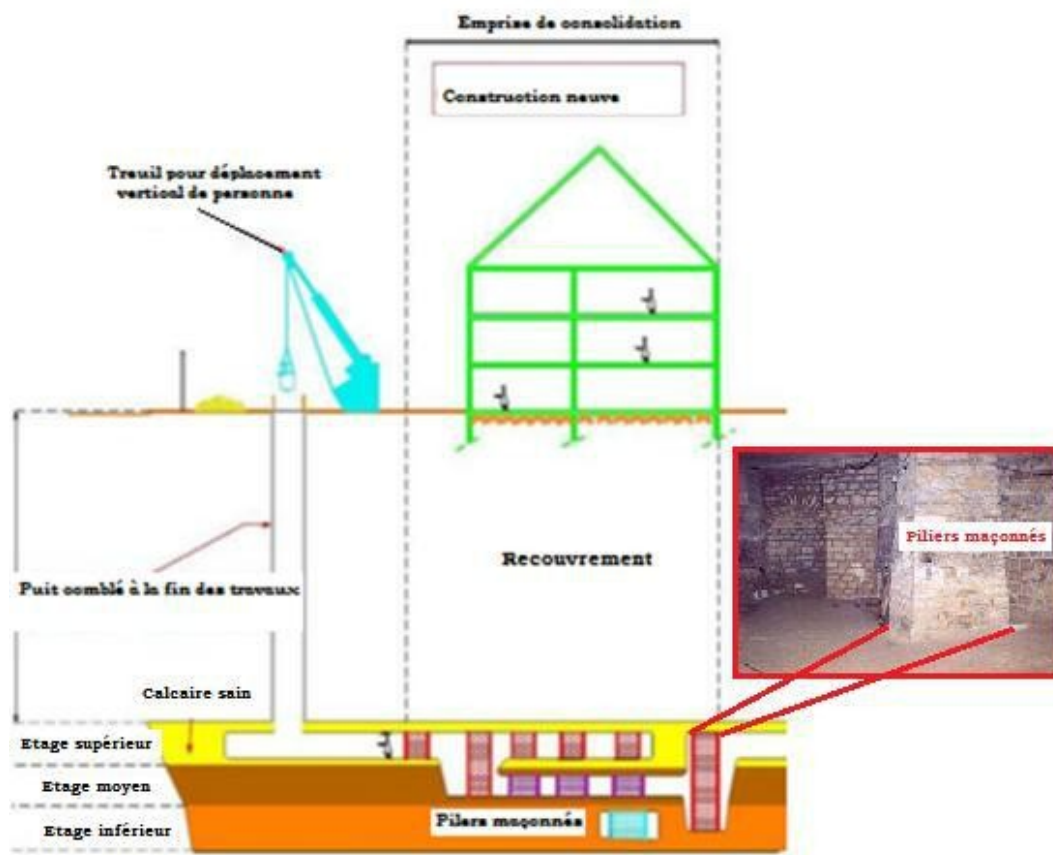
Consolidation par piliers maçonnés sous un bâtiment neuf
